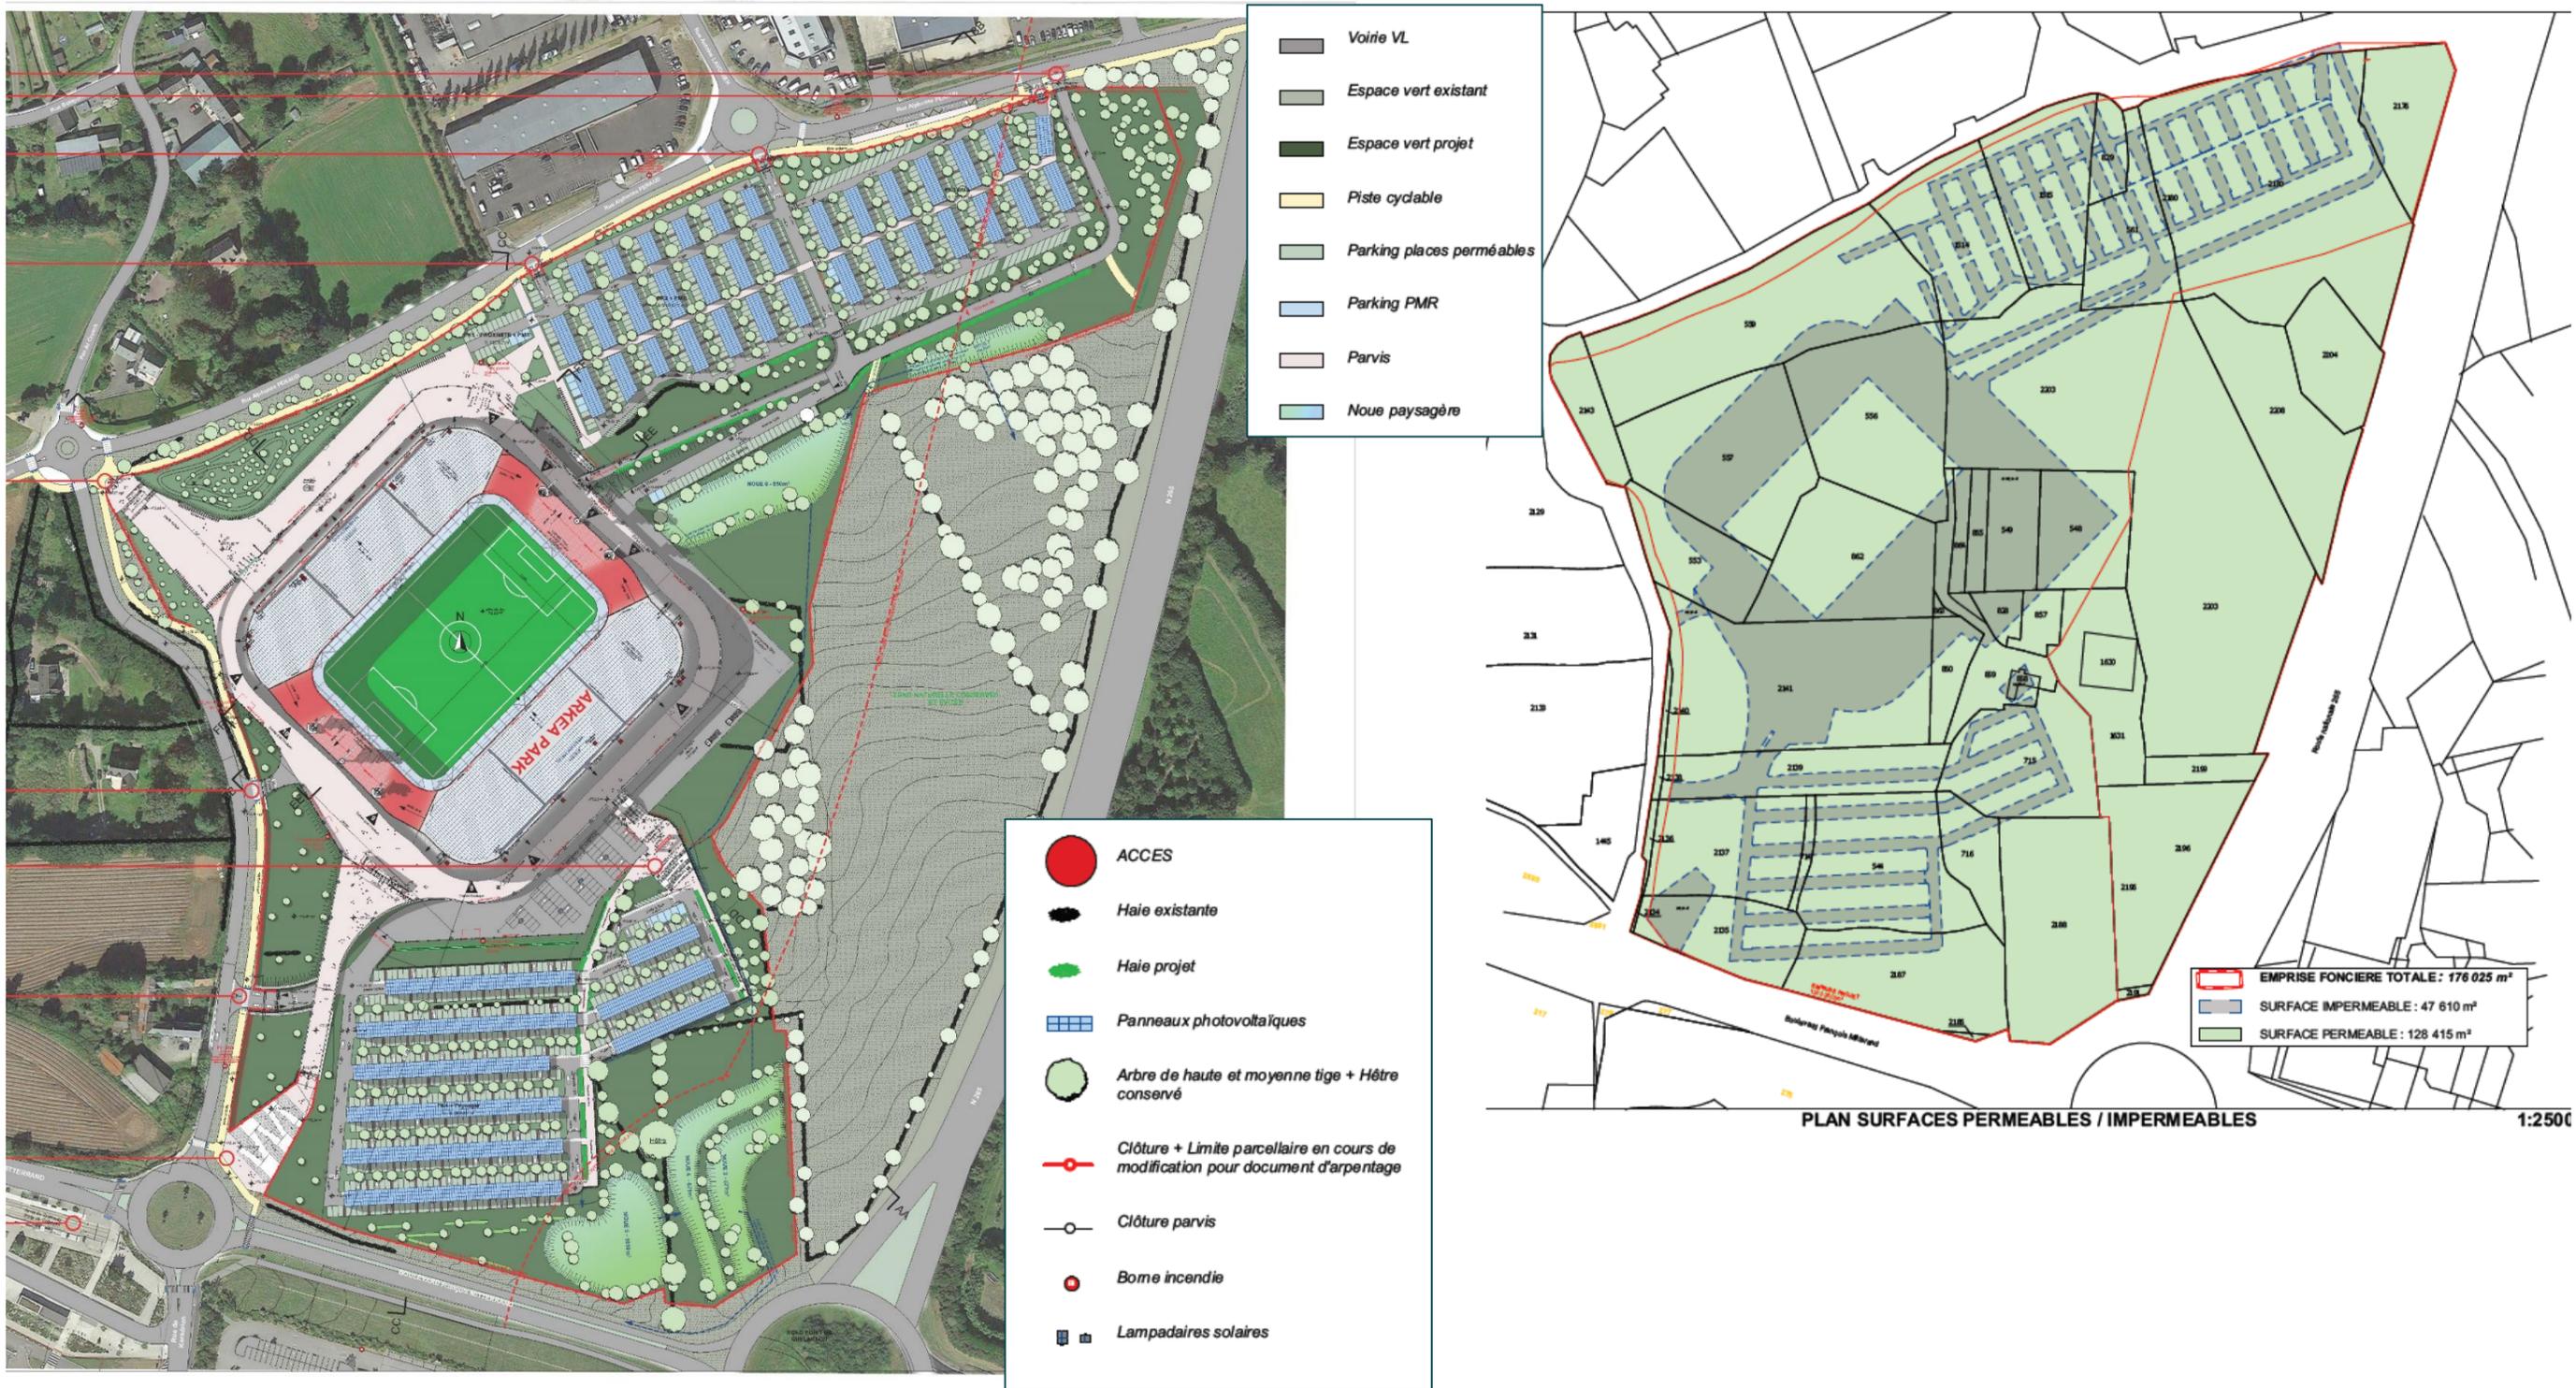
Plan de masse du projet (DE LA SERRE, 2025)
